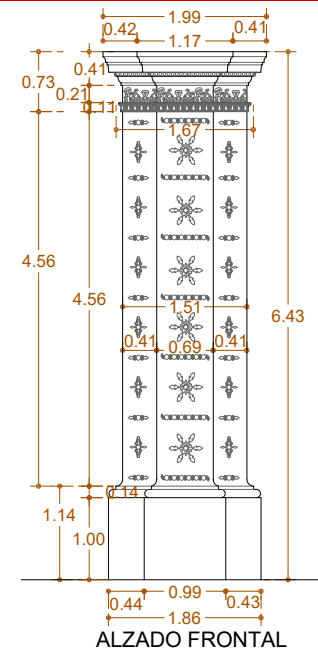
Detalle de basa de pilastra Norte de Nave Tramo 2 Vista Frontal
